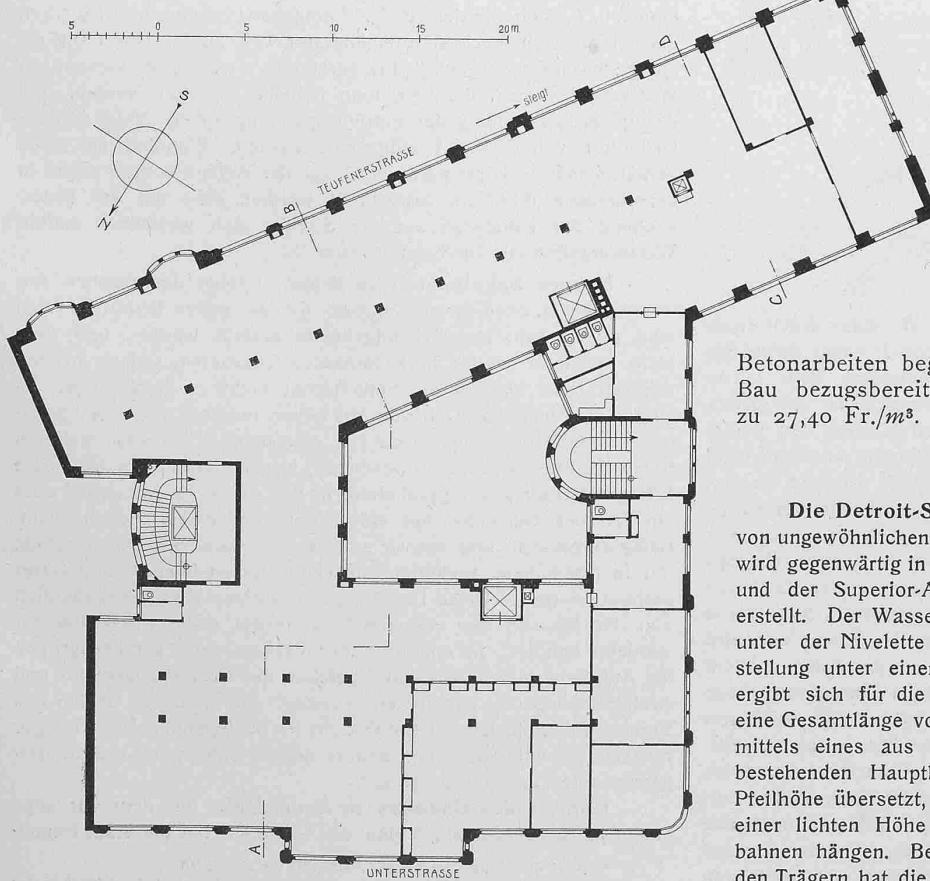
Geschäftshaus Reichenbach & Cie. — Grundriss 1:400.
